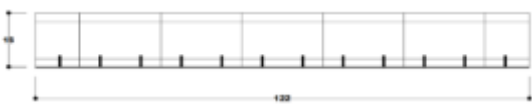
Benda Uji 1 Penampang Balok Beton Tanpa Pelat Baja.
